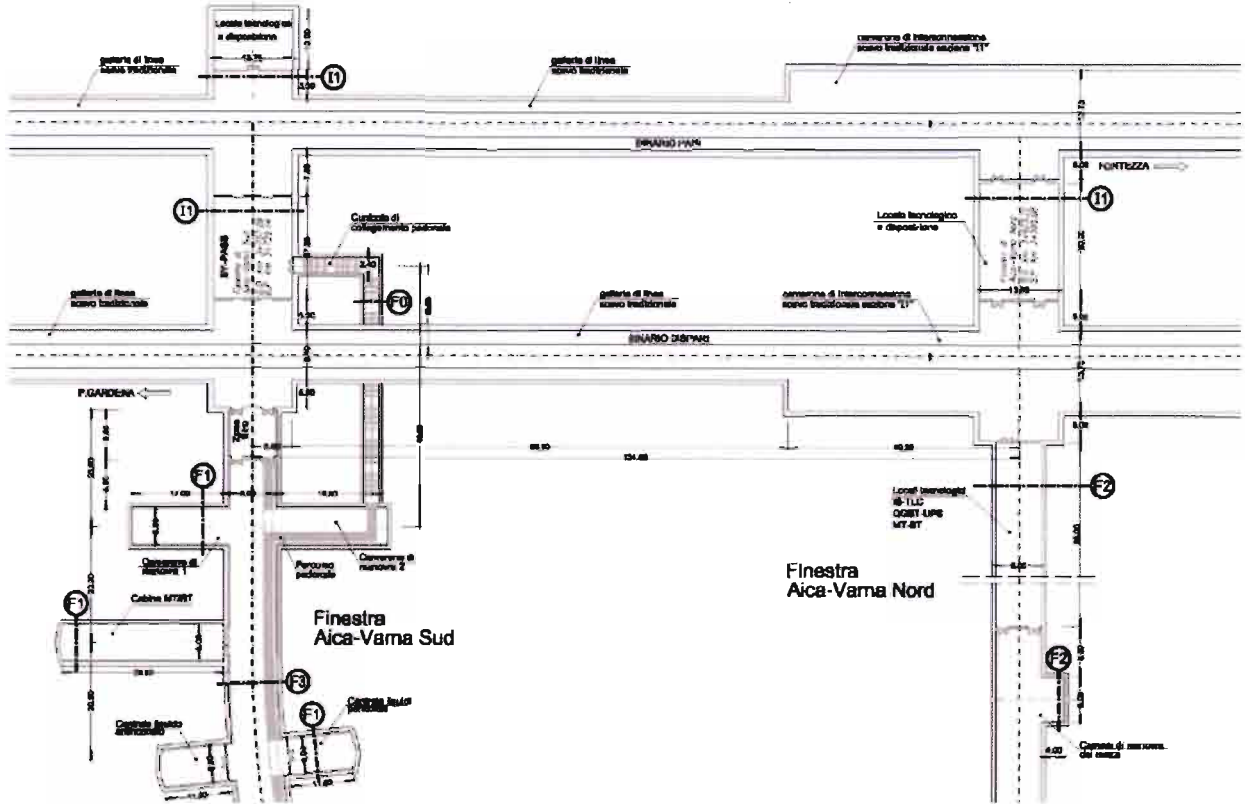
Stralcio planimetrico zona di innesto della finestra Varna Sud con le gallerie di linea.
